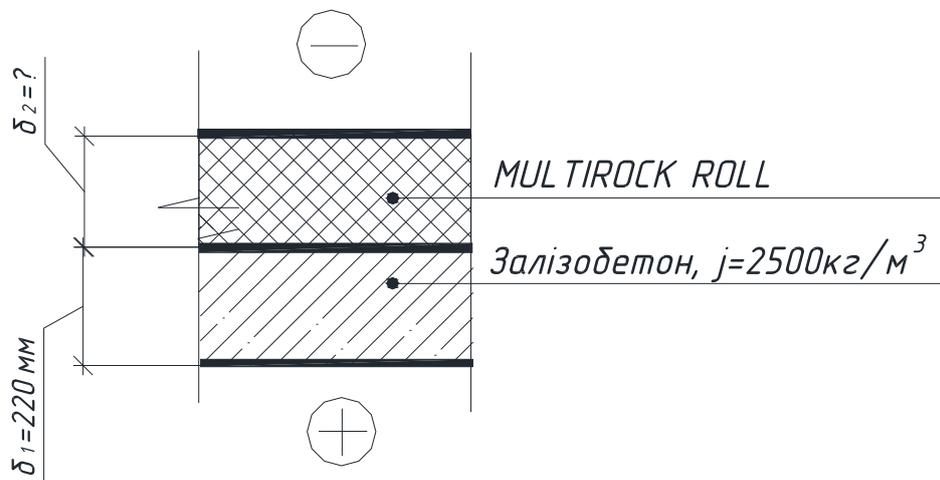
Розрахункова схема утепленого перекриття
